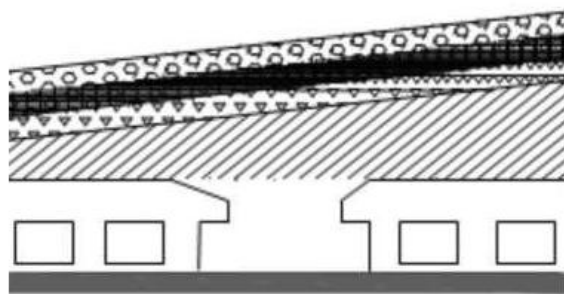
Section transversale d'un plancher (terrasse inaccessible).
